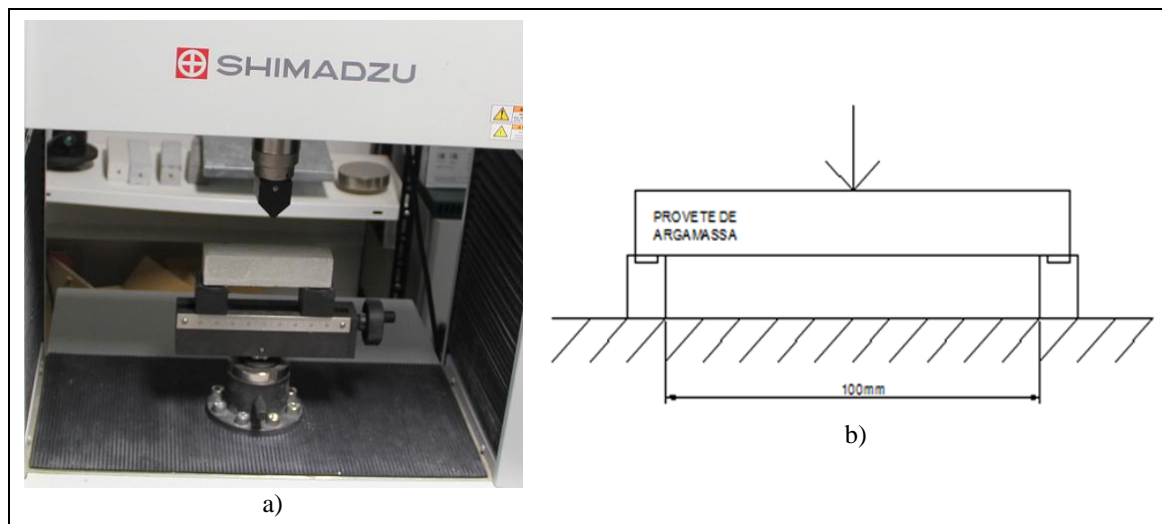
Ensaio à flexão: a) Ensaio real; b) Esquema do ensaio
